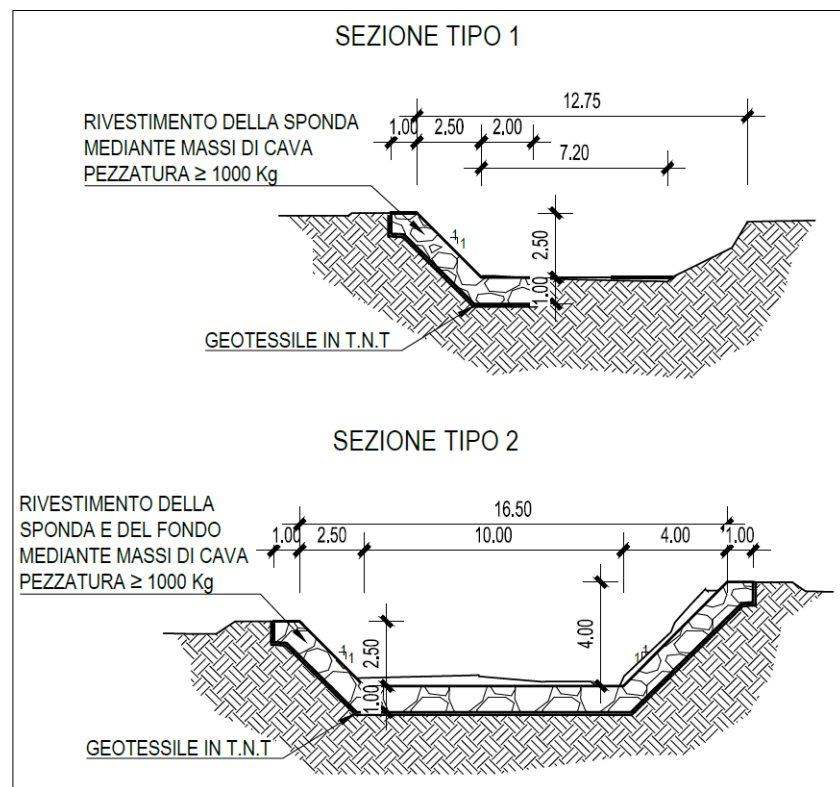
Sezione tipo delle opere di sistemazione idraulica.
